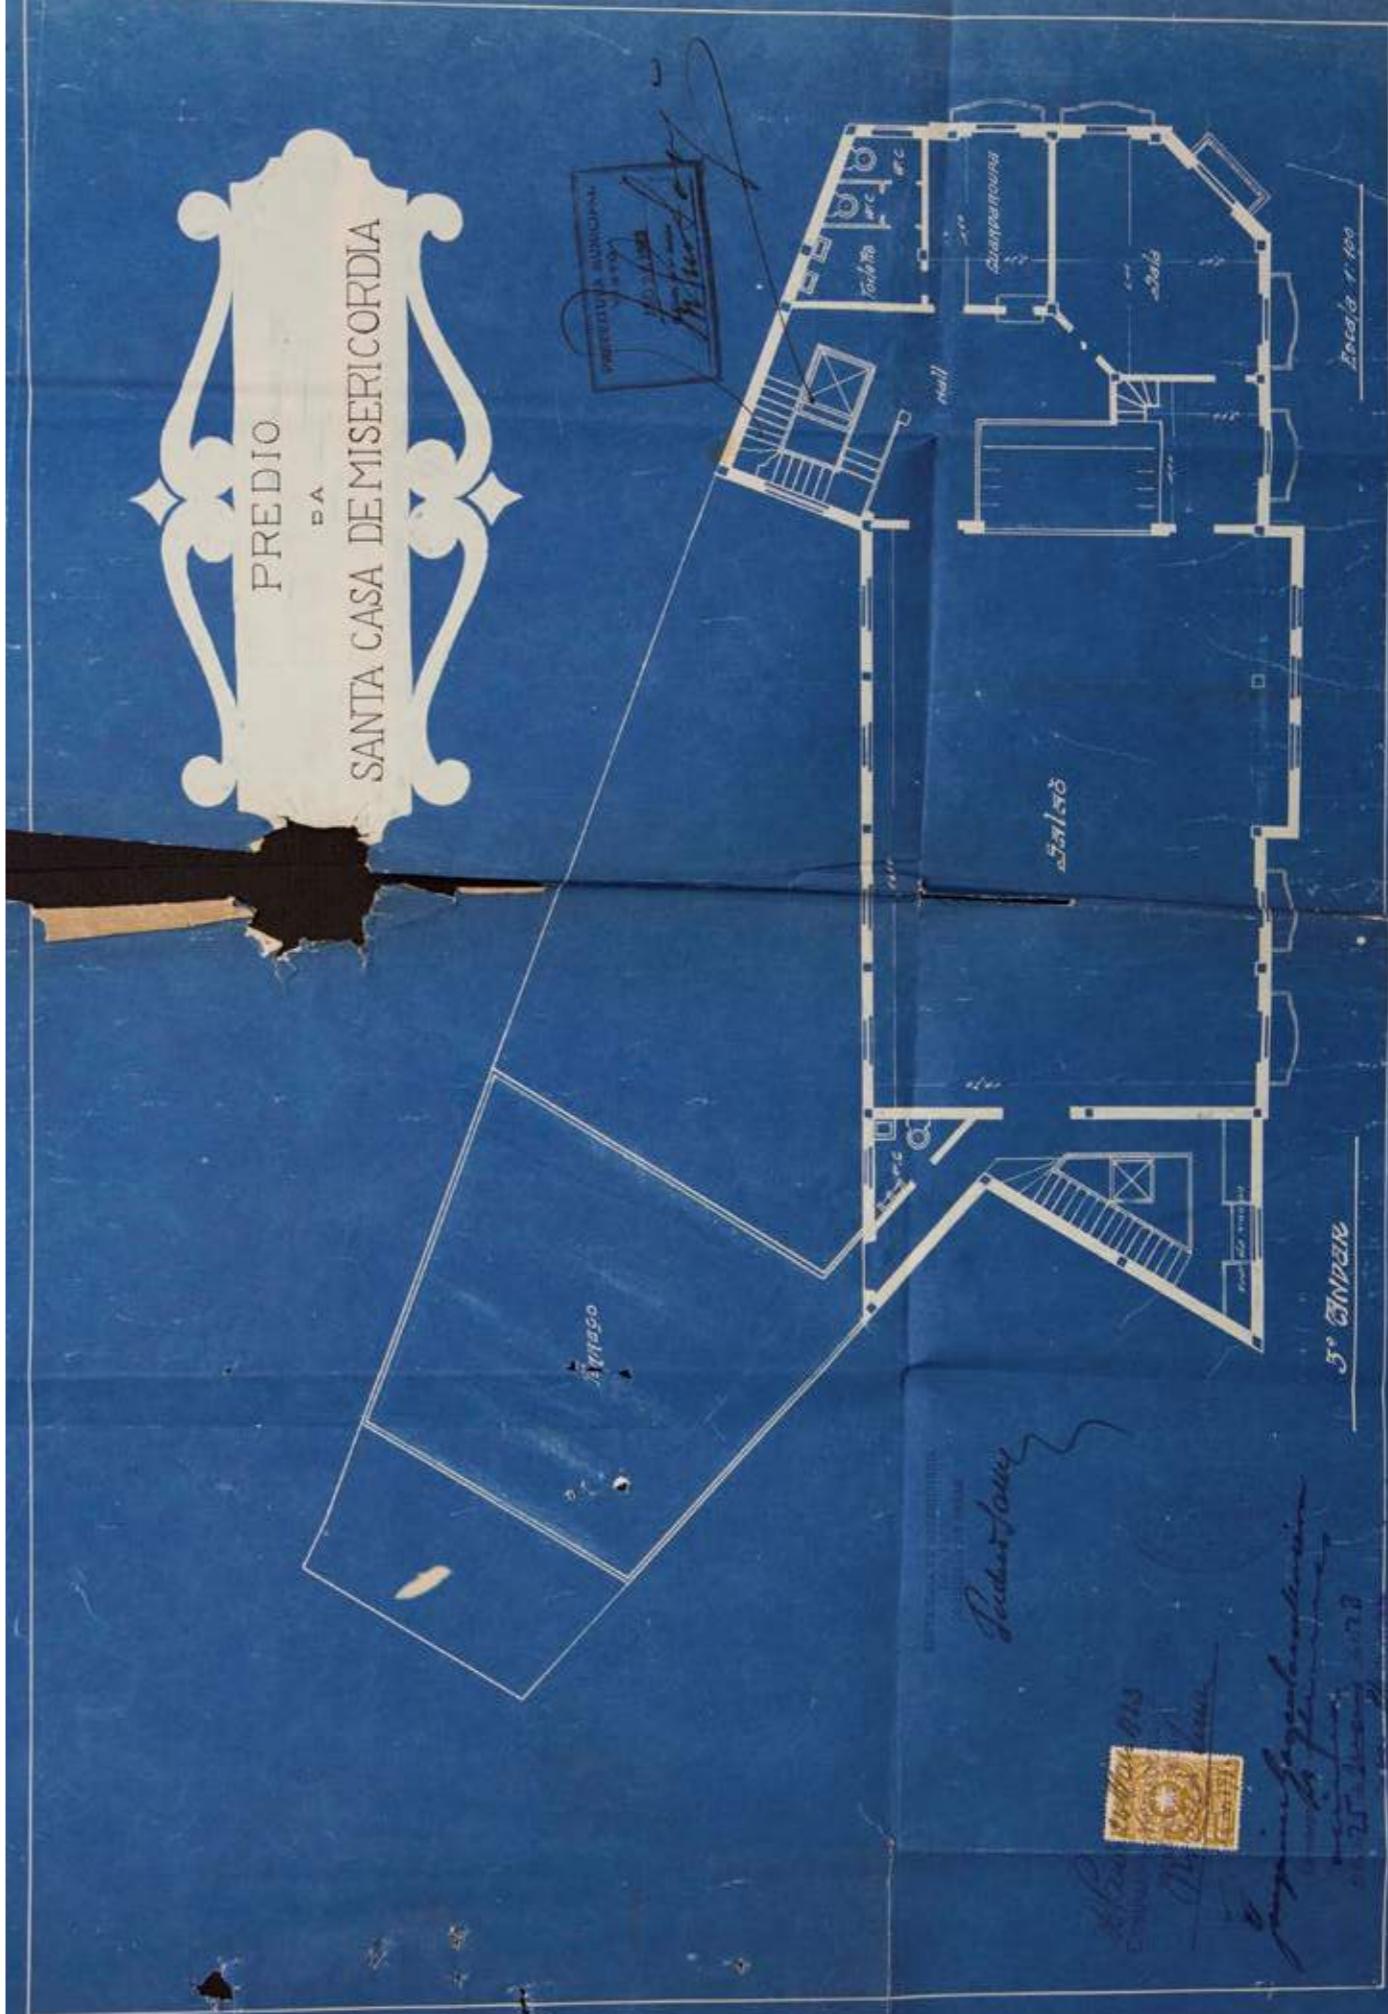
Planta do 4º pavimento (3º andar), 1923. Fonte: Arquivo Histórico de São Paulo.
